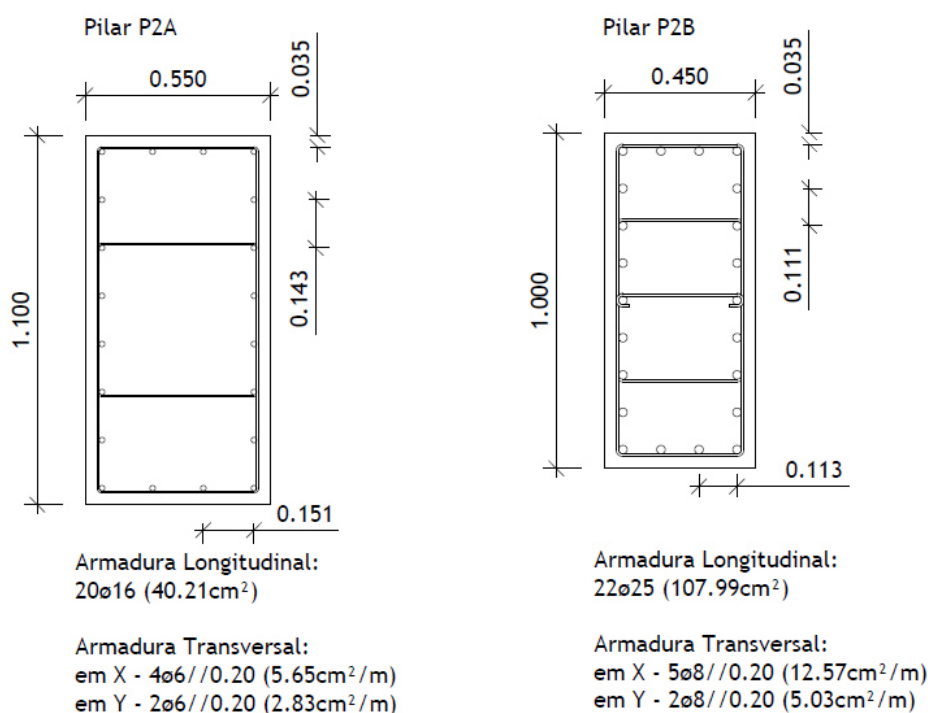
Esquema de armaduras longitudinais e transversais nos pilares
